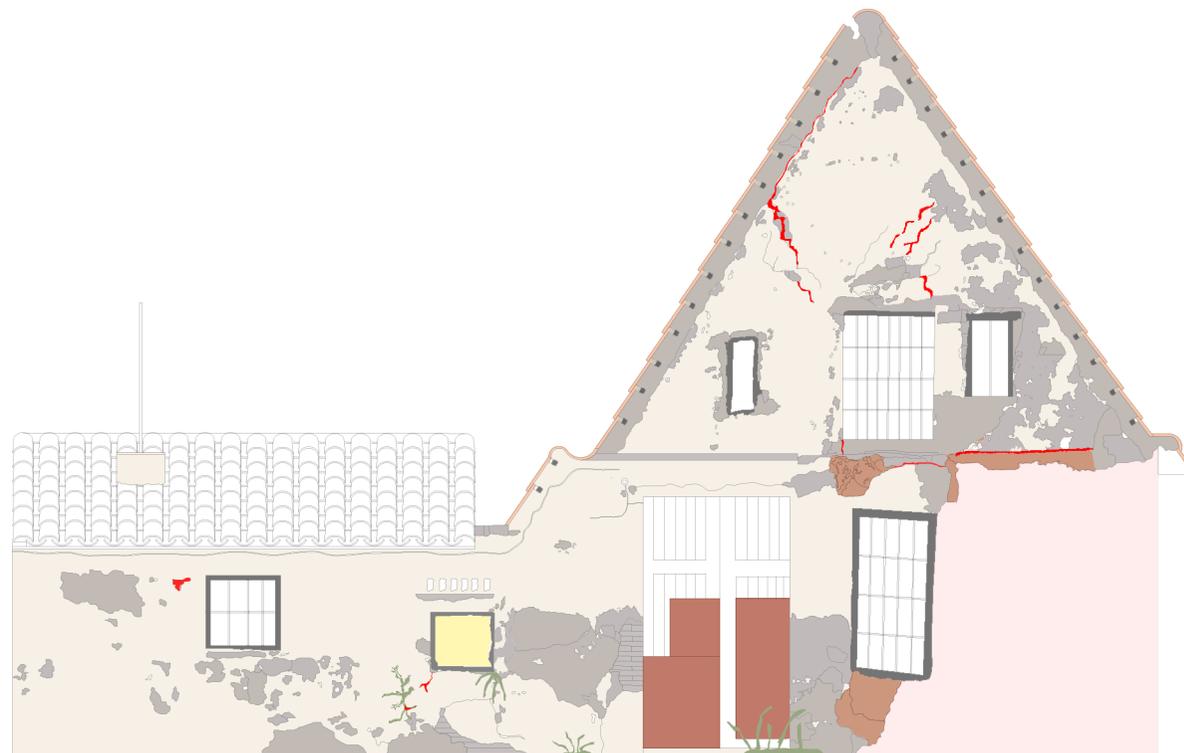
Plano fachada este patologías. Escala: 1/75. Fuente: Carlos Fuster Aparisi
